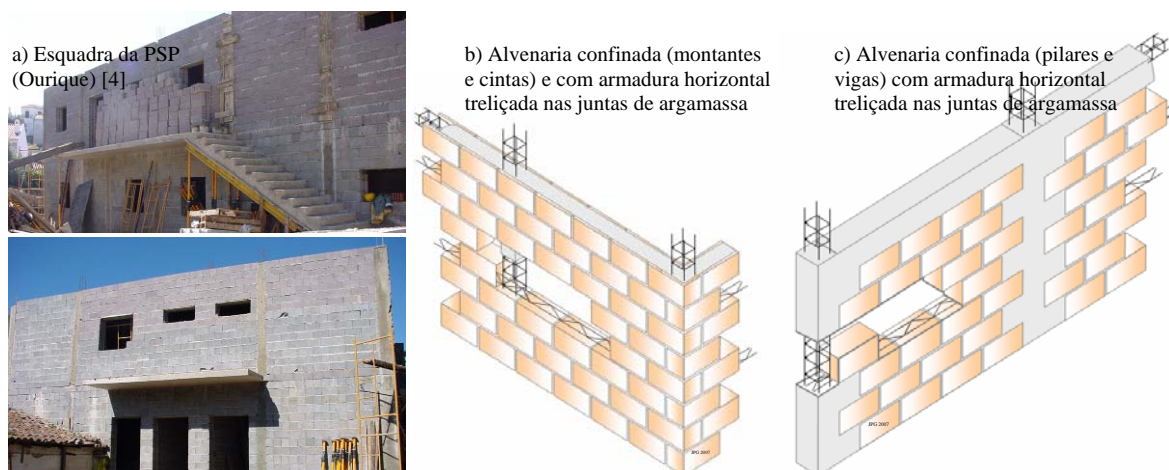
Exemplo de estruturas de alvenaria simples ou confinada, com armaduras.
